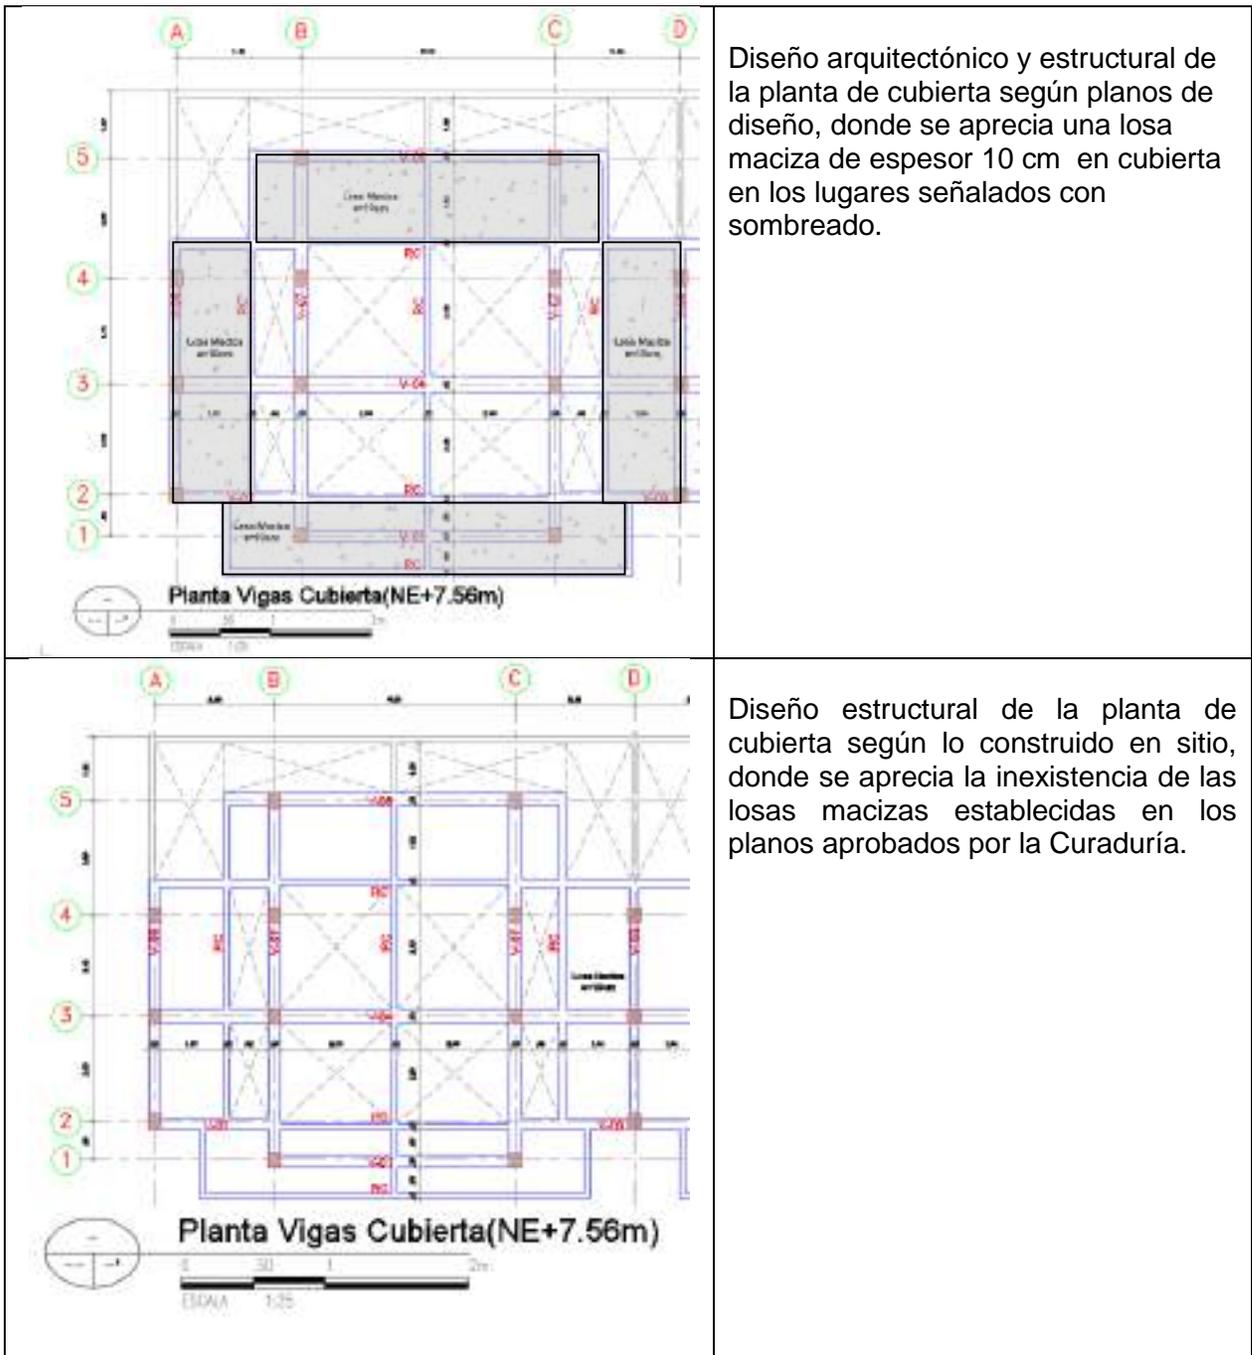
Diferencias encontradas en planos arquitectónicos y estructurales y la versión según lo construido.
